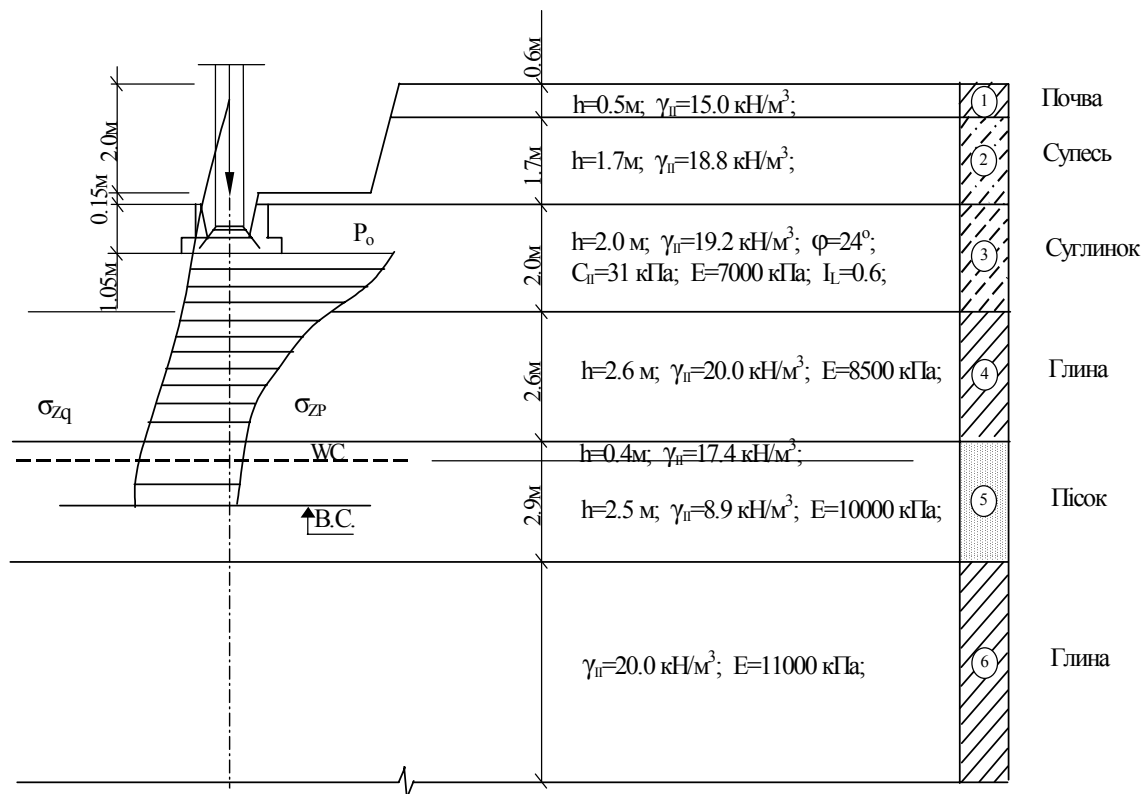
Схема розташування фундаменту в ґрунті
